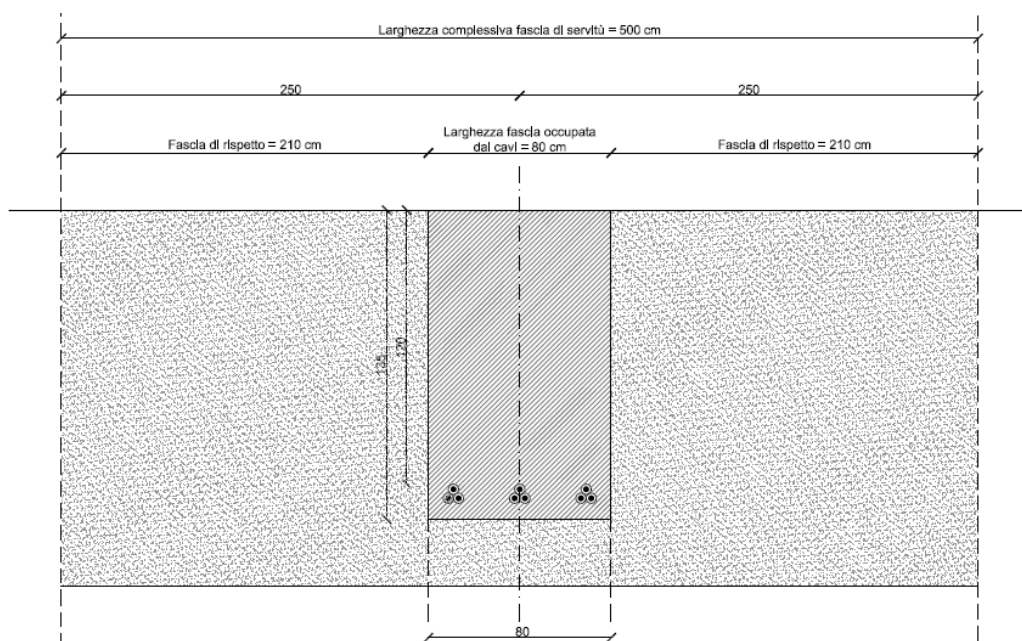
Sezione tipo scavo e fasce di rispetto per vincolo di servitù
